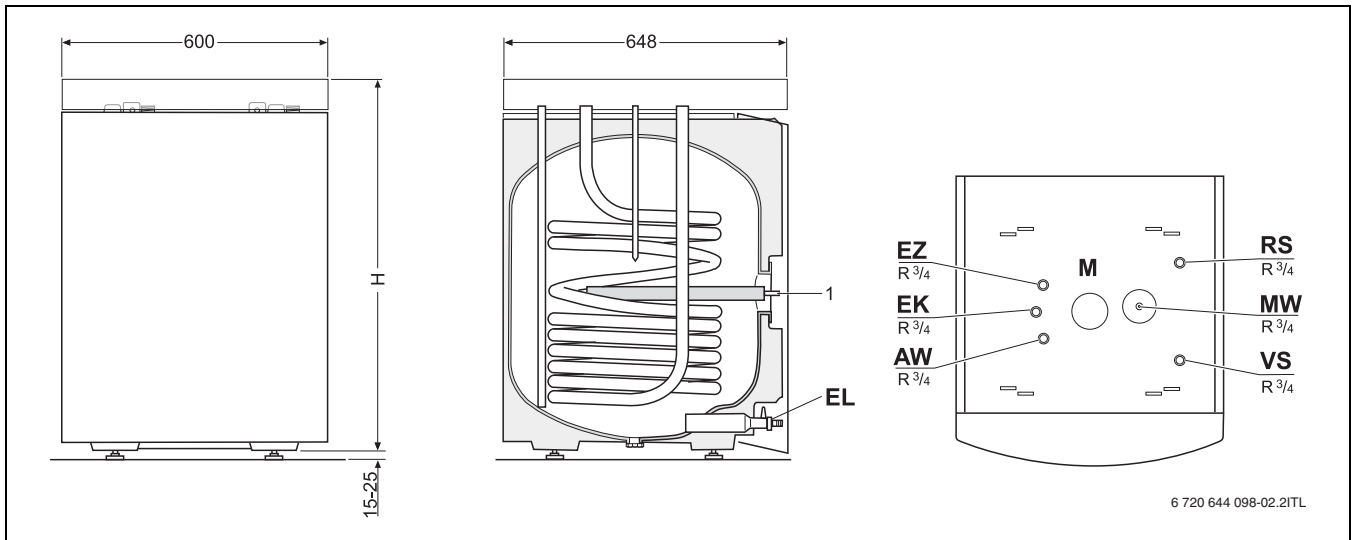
Abmessungen und Anschlüsse (Maße in mm)
